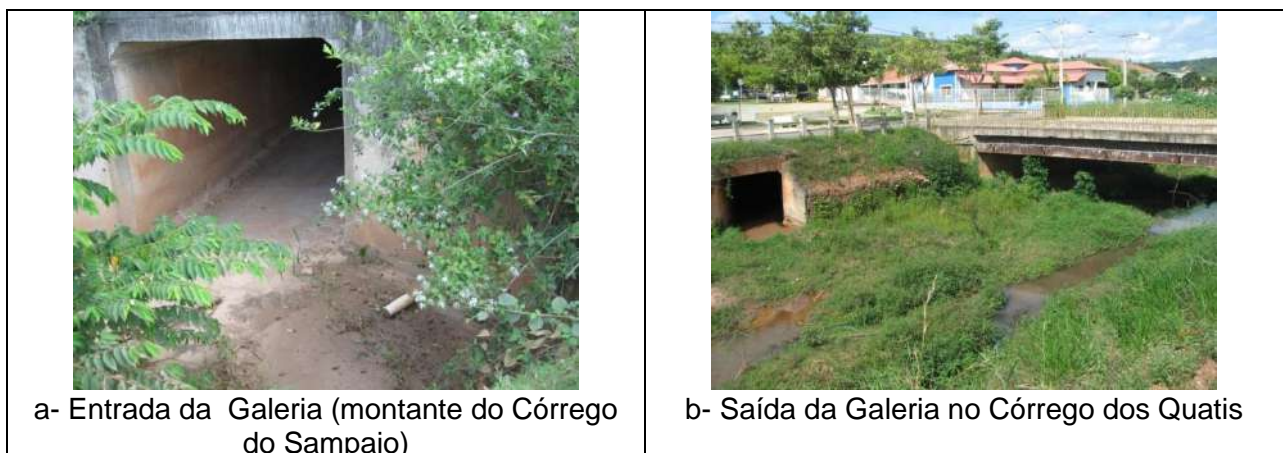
Detalhe da bacia do córrego do Sampaio.
